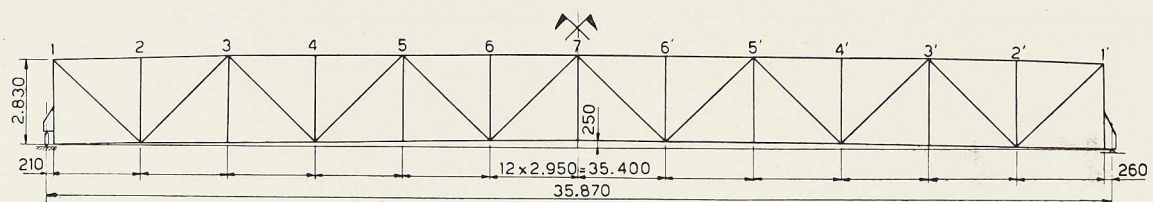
Elévation d'une maîtresse-poutre de la passerelle au-dessus de la Klybeckstrasse à Bâle.
